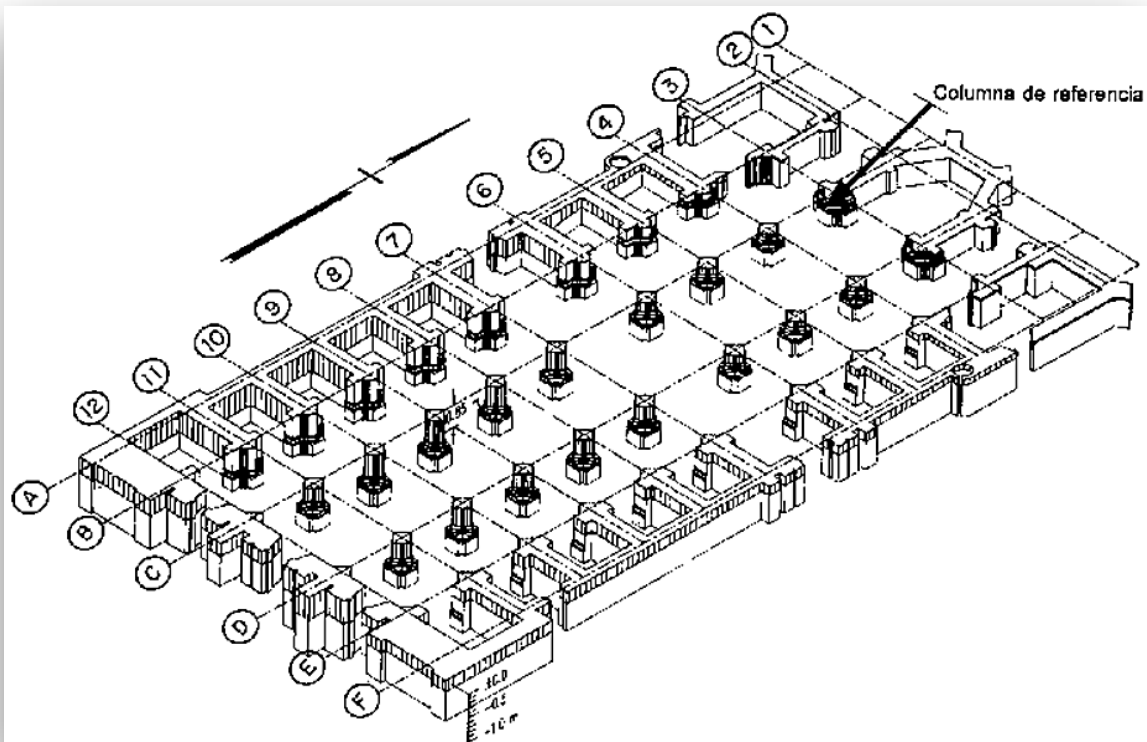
Aumento de alturas en columnas y muros durante el proceso constructivo
